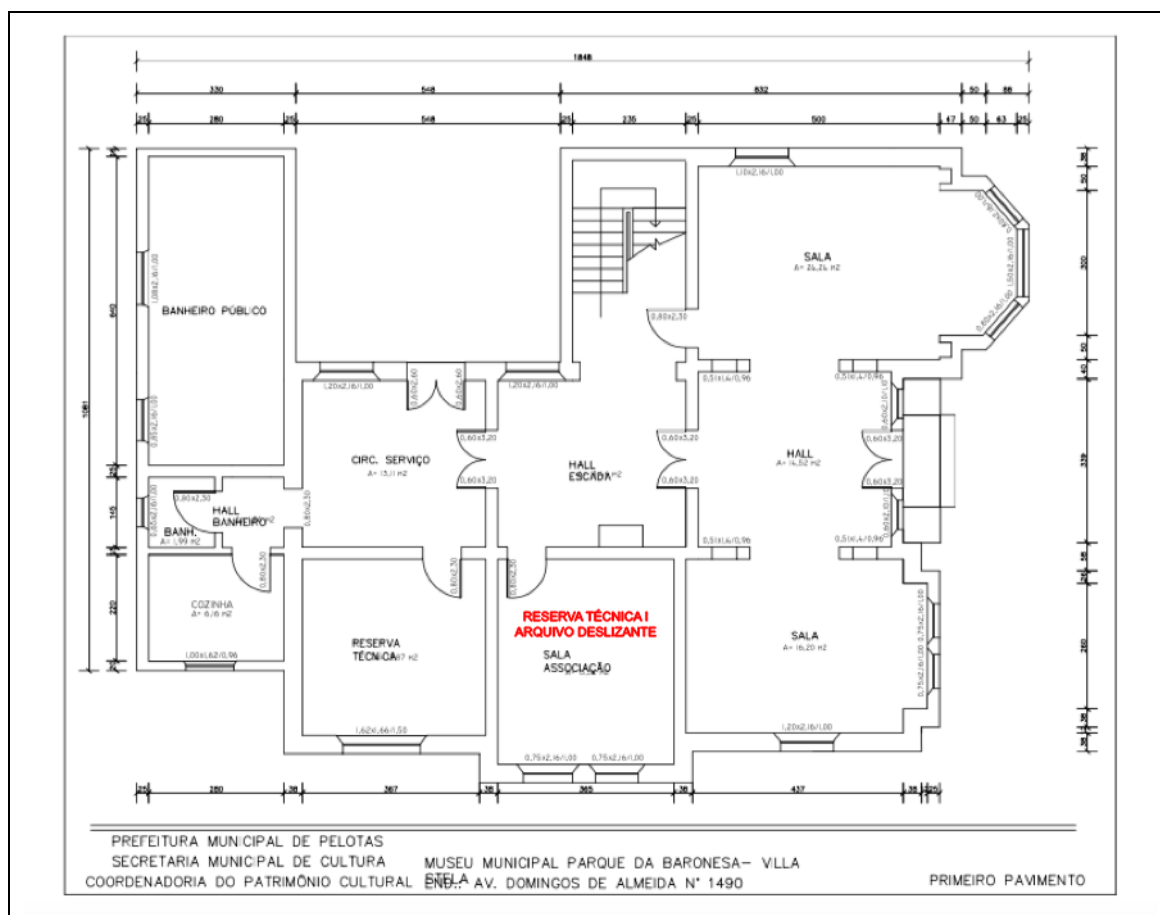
Planta Baixa do 2º pavimento da vila Stella em vermelho mostra onde esta localizado o acervo do Museu.
